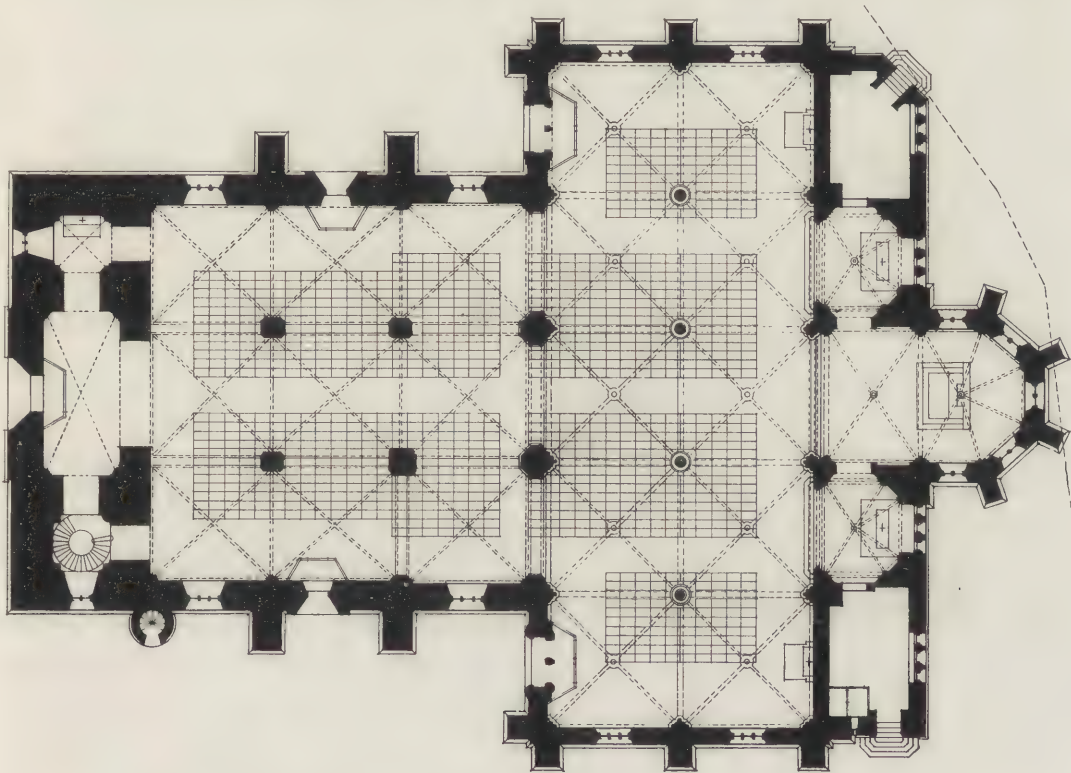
Grundriss der katholischen Stadtpfarrkirche zu Leobschütz nach dem Umbau.
